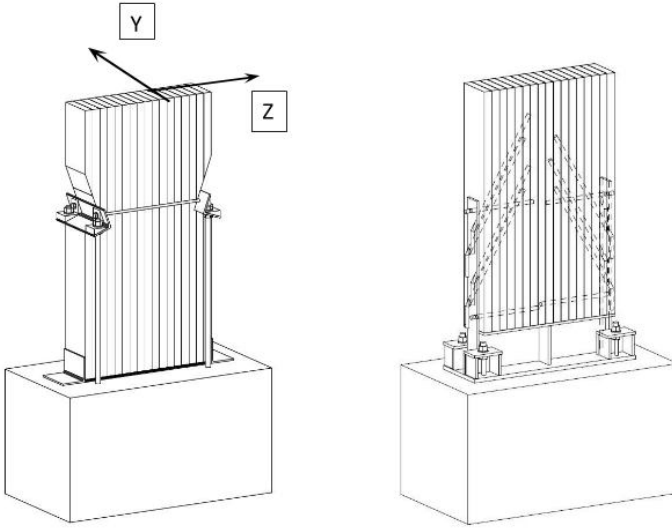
Варіанти жорсткого кріплення колон до фундаменту
